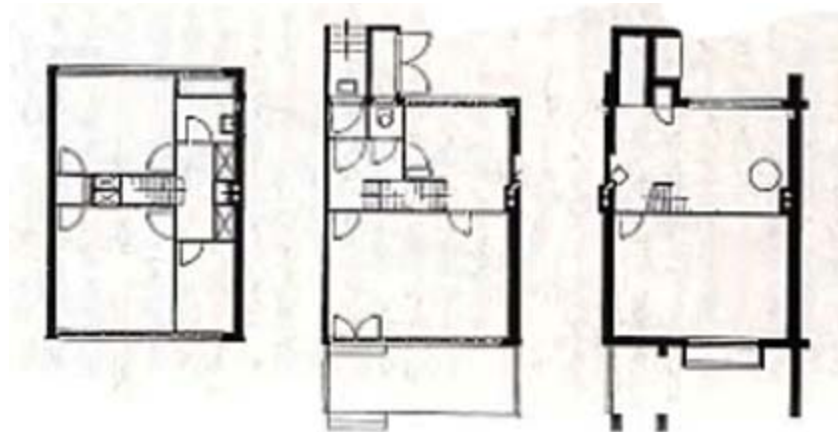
, Planta tipo Viviendas Unifamiliares Colonia Dammerstock, año 1928-1929, Walter Gropius.
